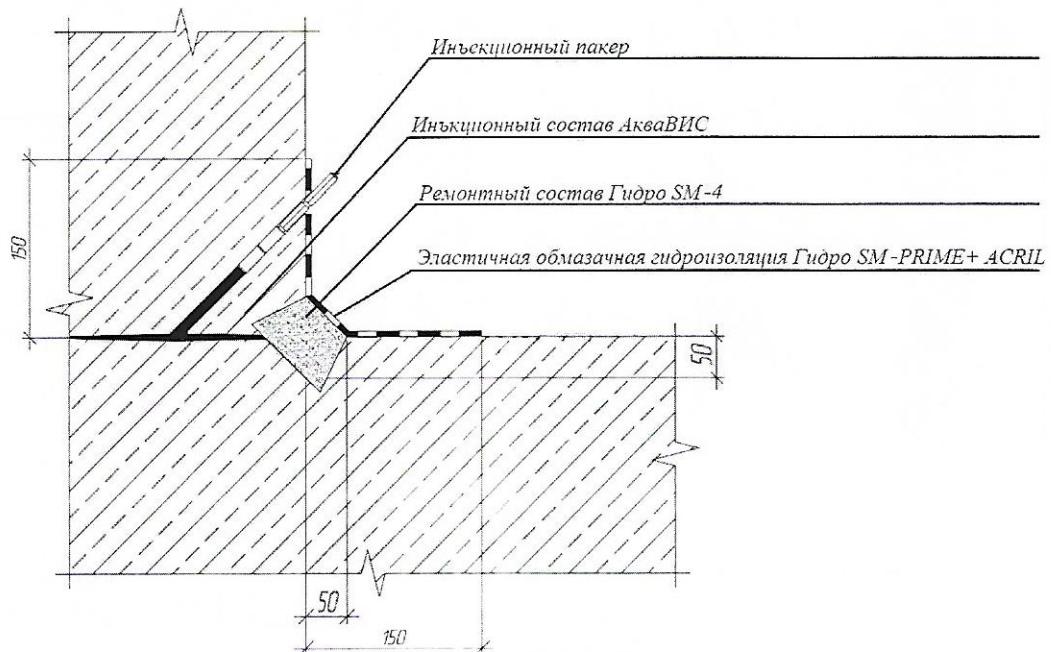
Схема гидроизоляции рабочих швов и трещин, расположенных в местах примыкания
